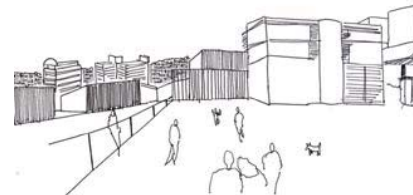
Croquis proyecto grupal barrio puerto. Fuente: elaboración propia
